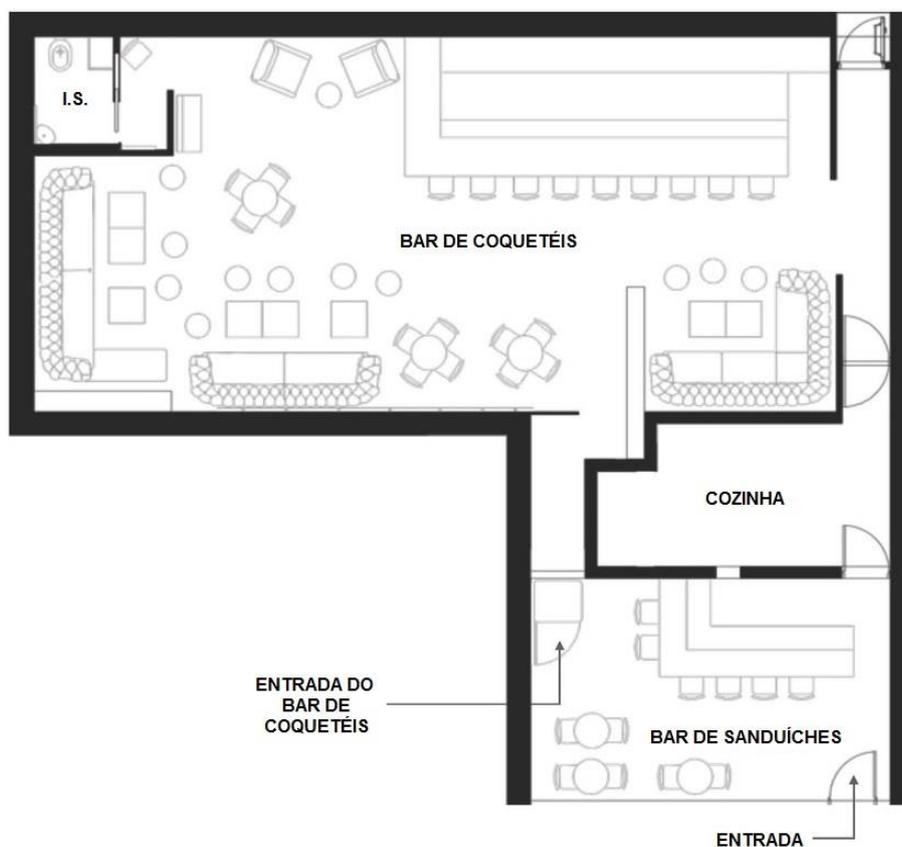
Planta baixa do Bar Flask. FONTE: ARCHDAILY (2015).
